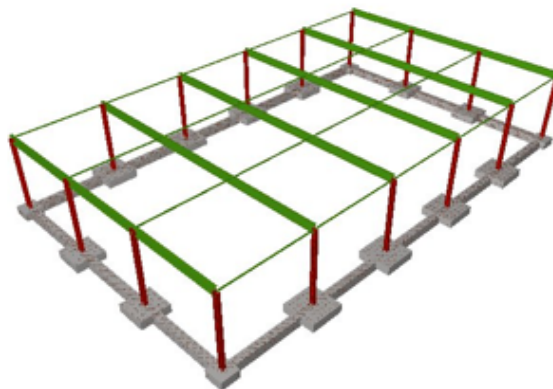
Estructura del edificio. Elaboración propia con CYPE
